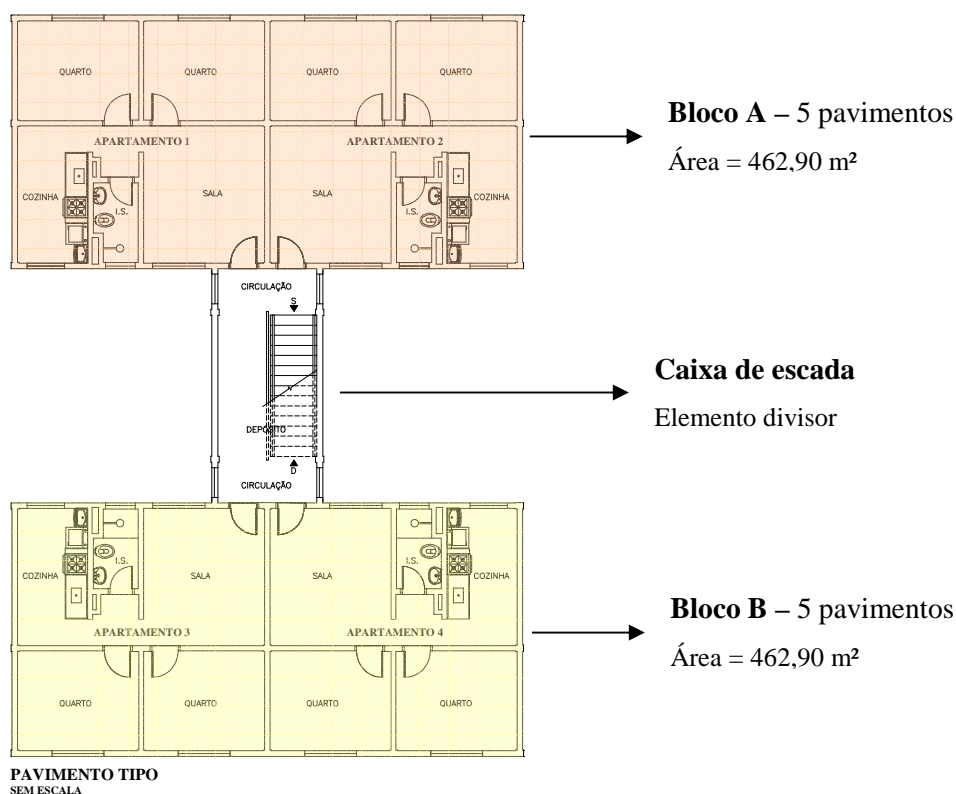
Planta do pavimento tipo e áreas por blocos.
